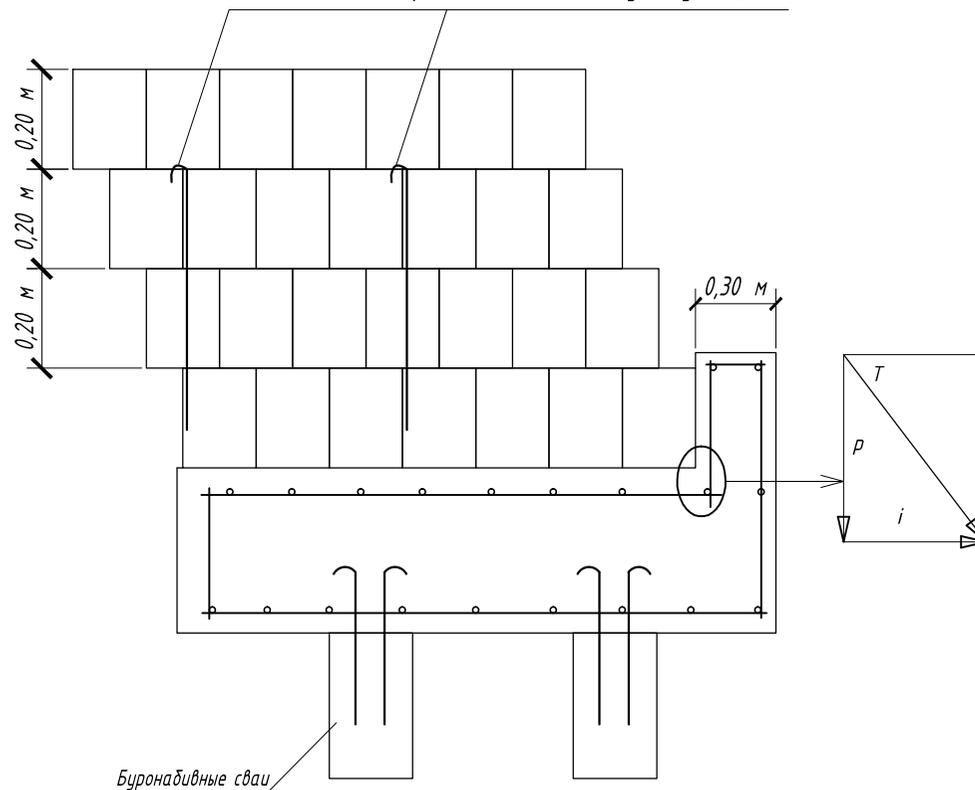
Типовая схема армогрунтовой подпорной стенки
